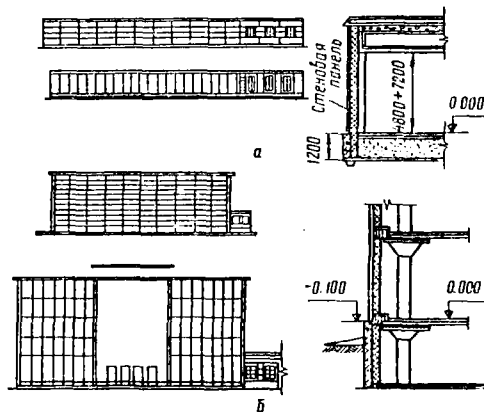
Фасады и конструкции наружных стен из сборных горизонтальных и вертикальных панелей одноэтажных (а) и многоэтажных (б) холодильников.
